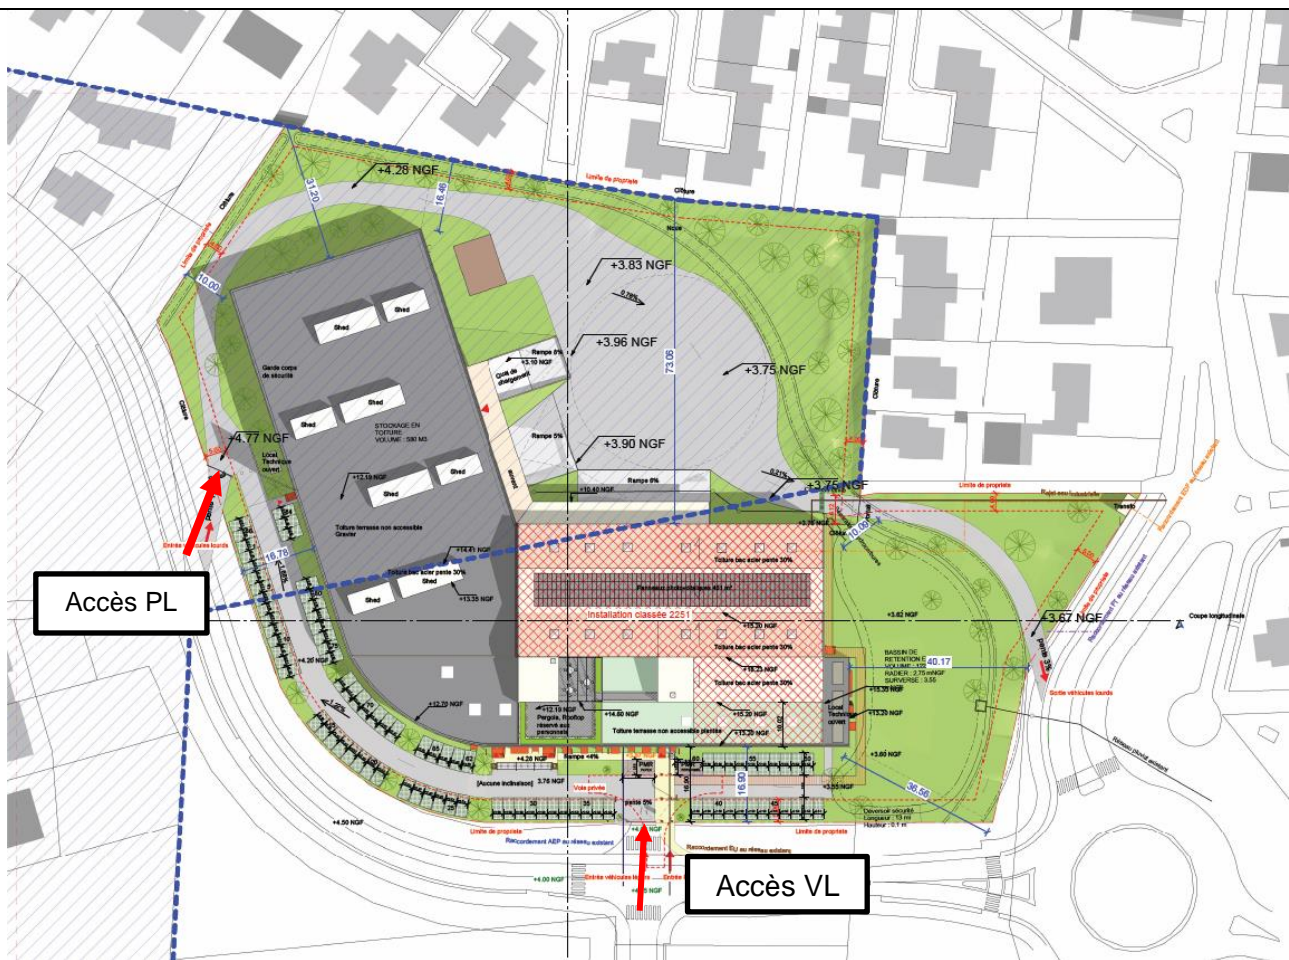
Plan d'accessibilité des secours (Source : NAOS Architecte)
